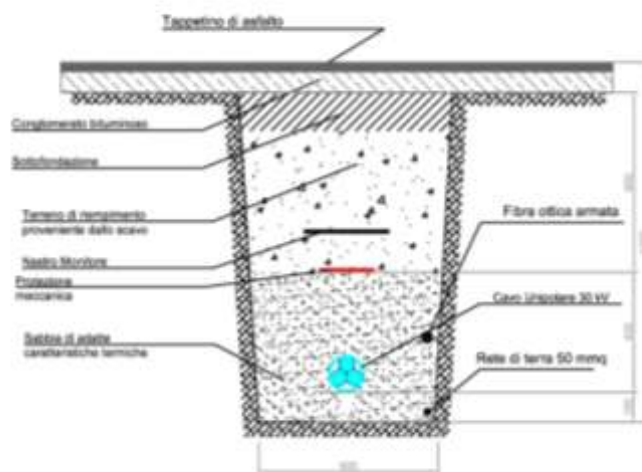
Sezione tipica di posa della linea in cavo su sede stradale asfaltata (1B)
